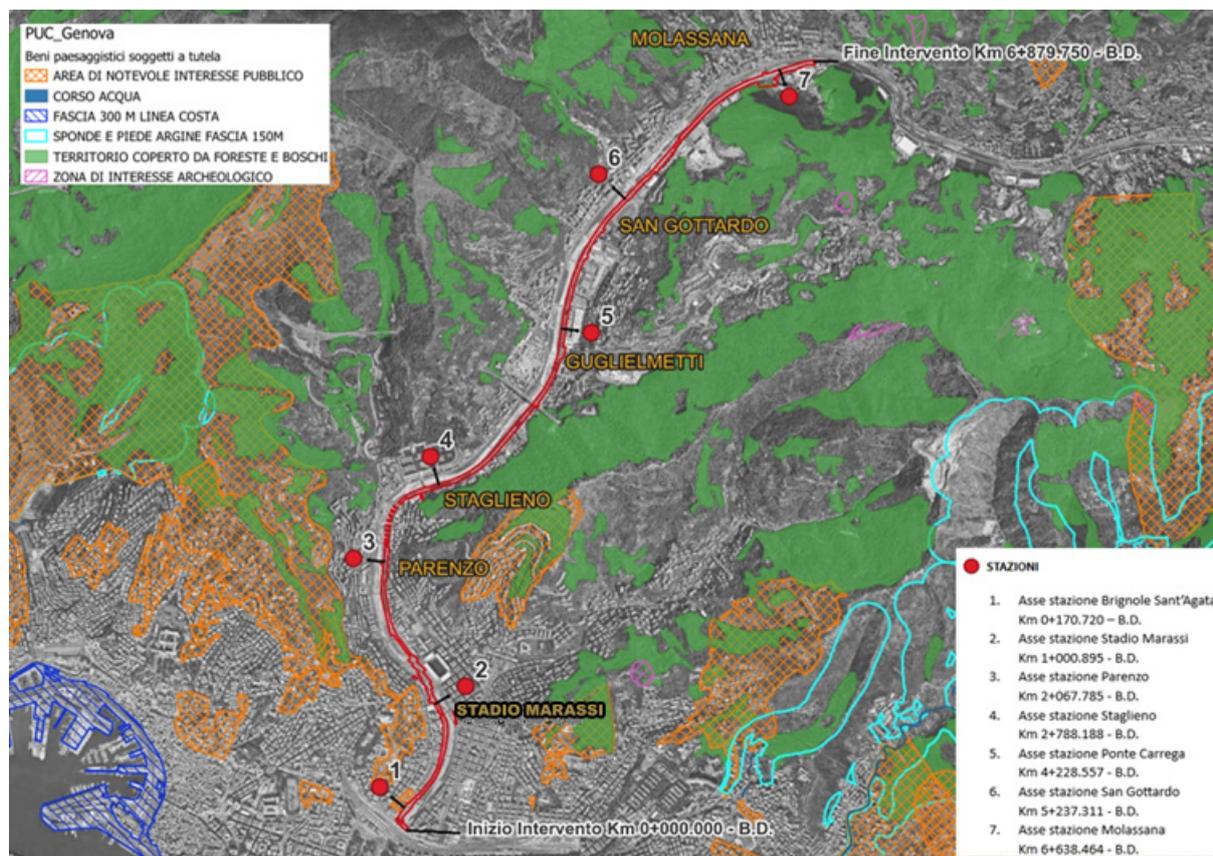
Planimetria degli interventi di progetto con sovrapposizione vincoli paesaggistici (Fonte <https://mappe.comune.genova.it/>)
